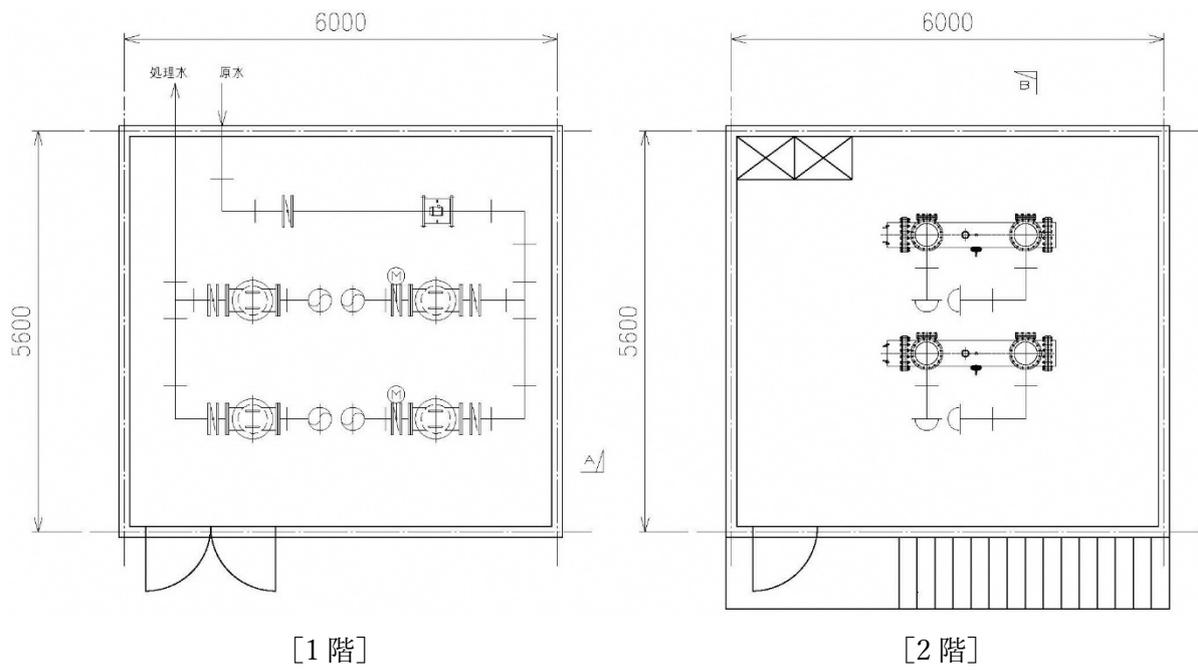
平面配置図 (14,000 m³/日、低圧ランプ)
